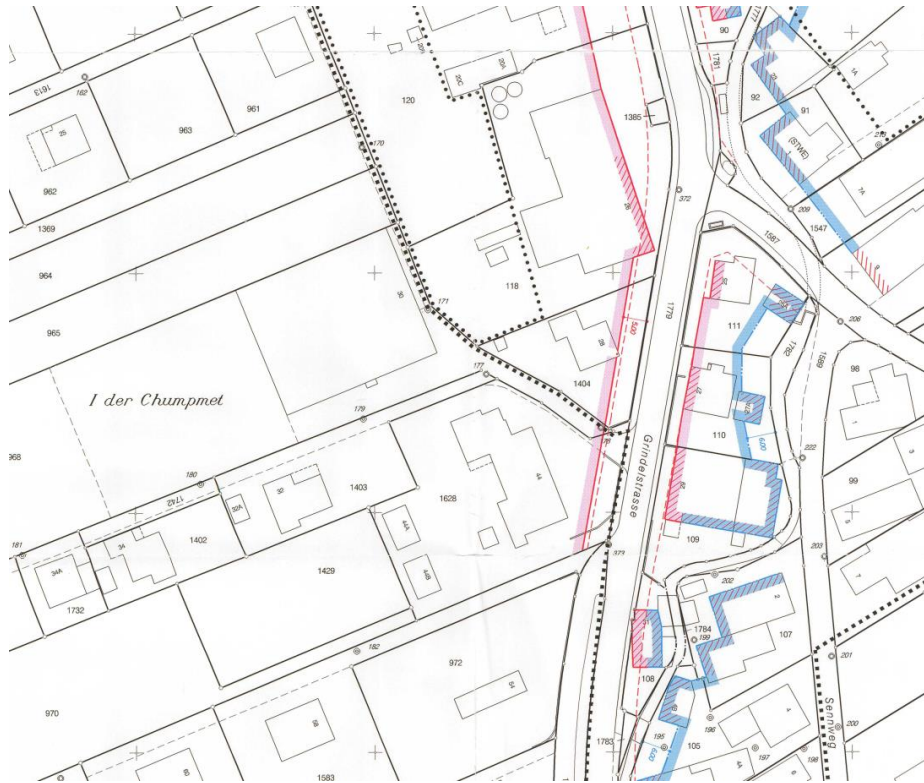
Ausschnitt Baulinienplan Kantonsstrassen und Gewässer „Dorfkern“ – Laufenstrasse / Grindelstrasse / Wahlenbach (43.1.0102-1C)
